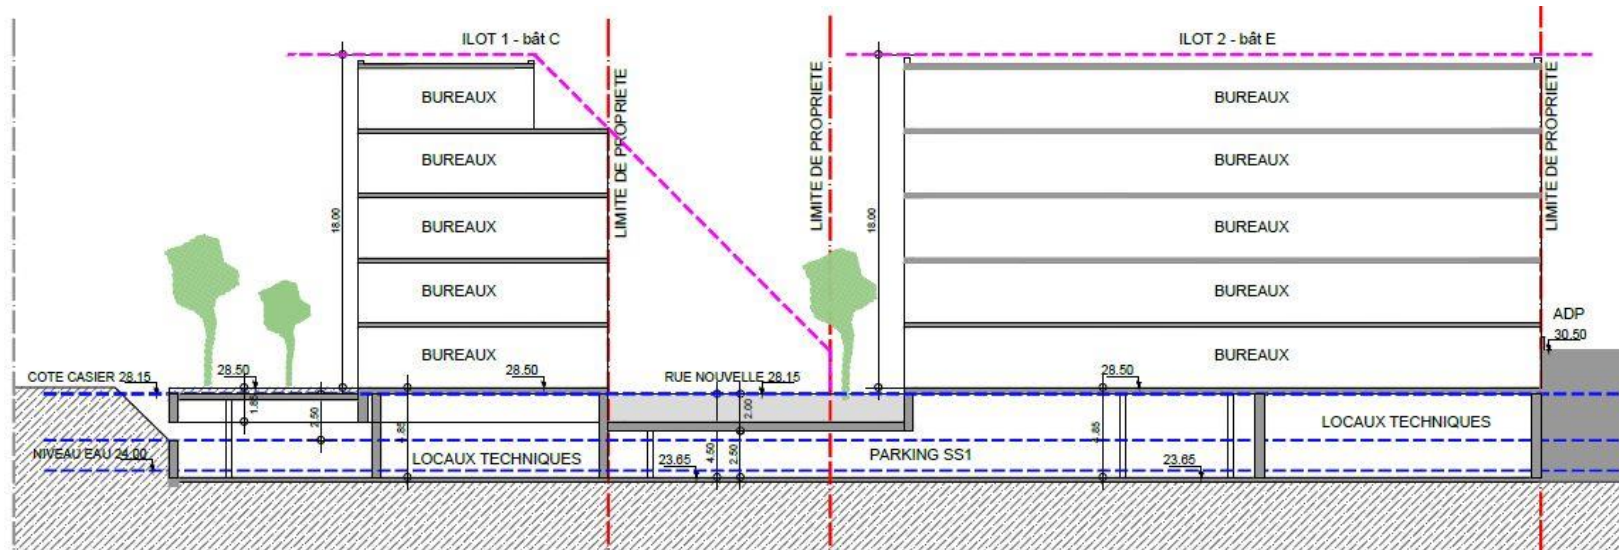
Coupe longitudinale des bâtiments C et E (source : CALQ, avril 2020)
